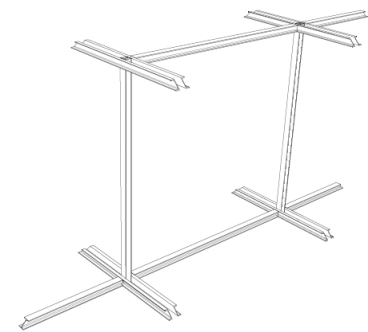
Sistema de soportes y crucetas metálicas. [Fuente: Estructuras Singulares | UPV]
